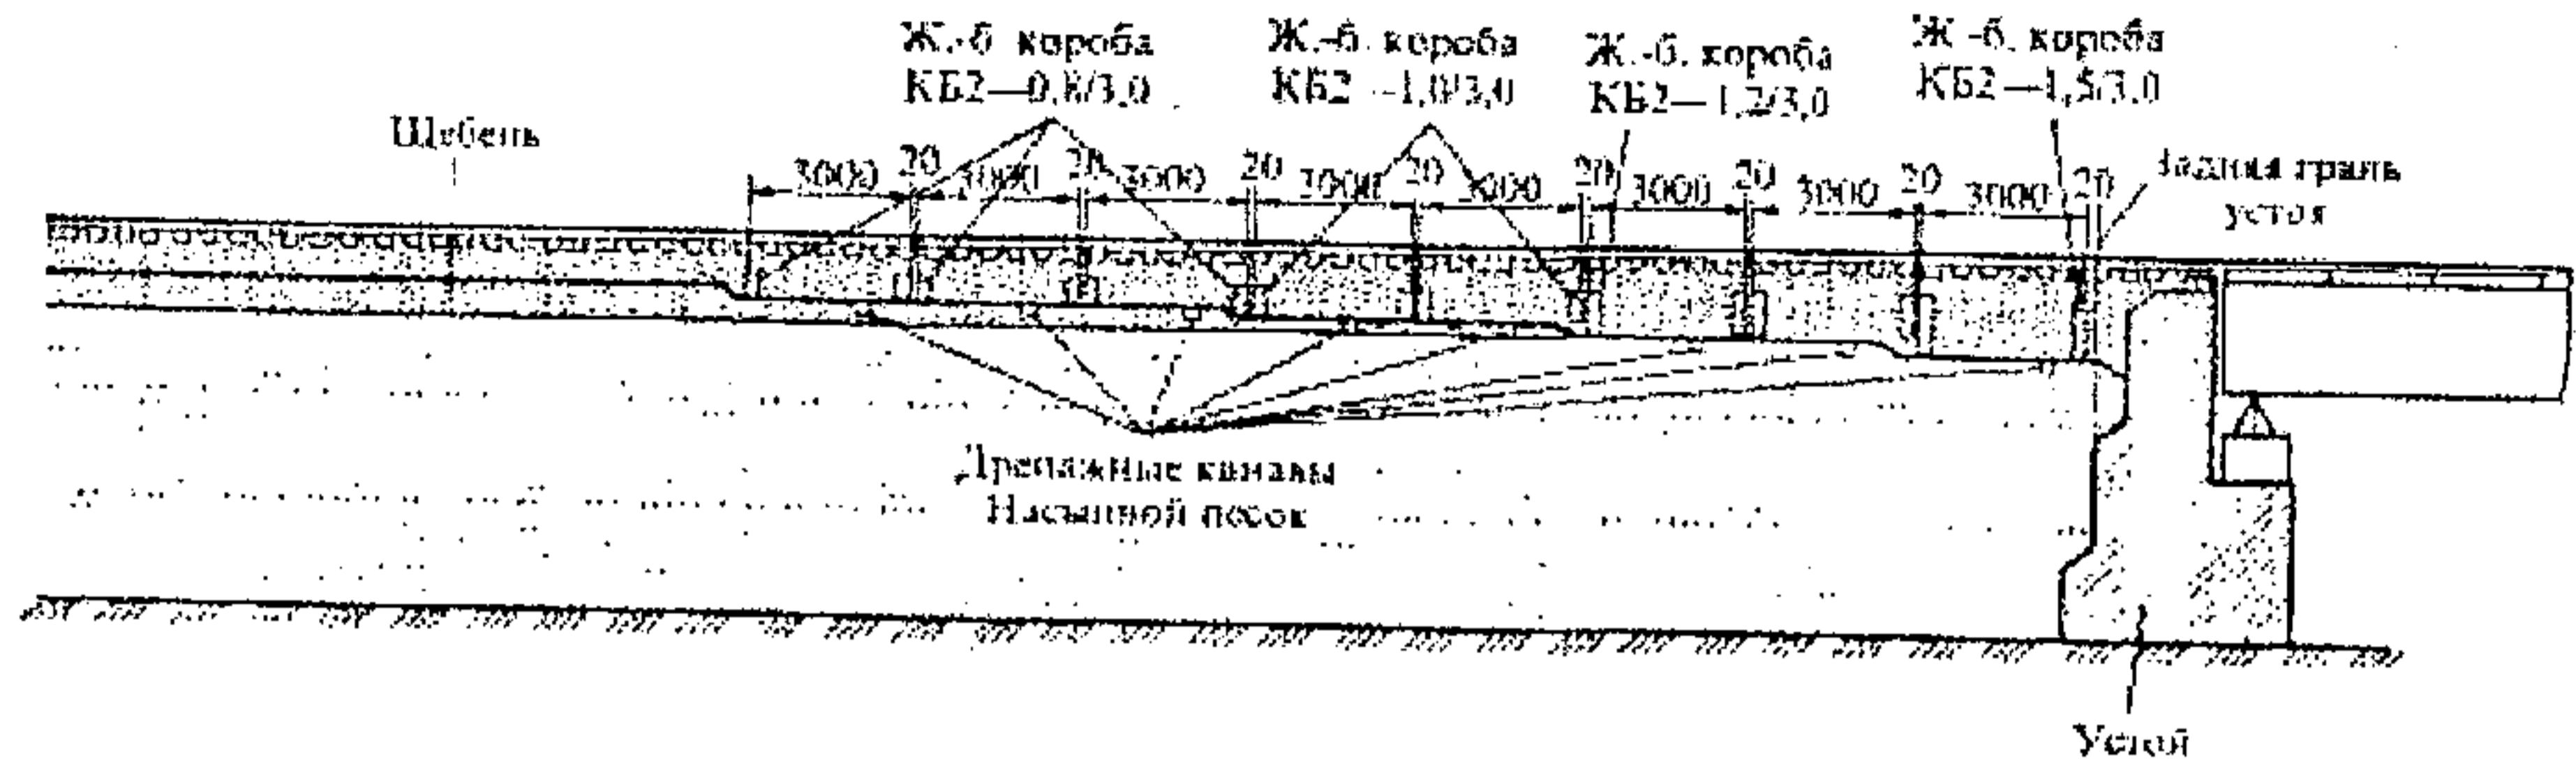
Переходной путь из бездонных железобетонных блоков жесткости
